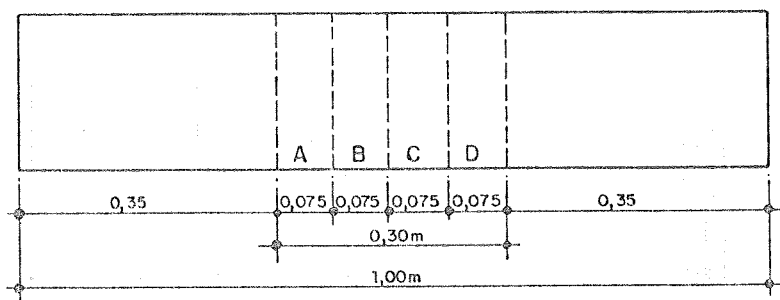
Regiões de observação da abertura de fissuras nos ensaios de flexão. O terço médio da viga -- 30 cm -- foi dividido em 4 regiões de 7,5 cm. O espaçamento entre fissuras foi acompanhado junto à linha média da largura da peça, acusada na figura.
